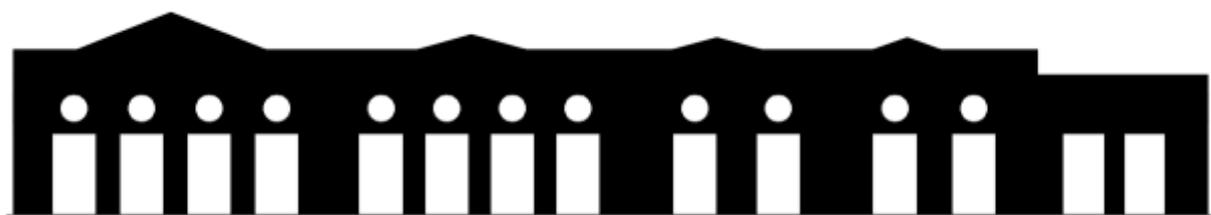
Análise de cheios e vazios da fachada do Morada das Artes.
